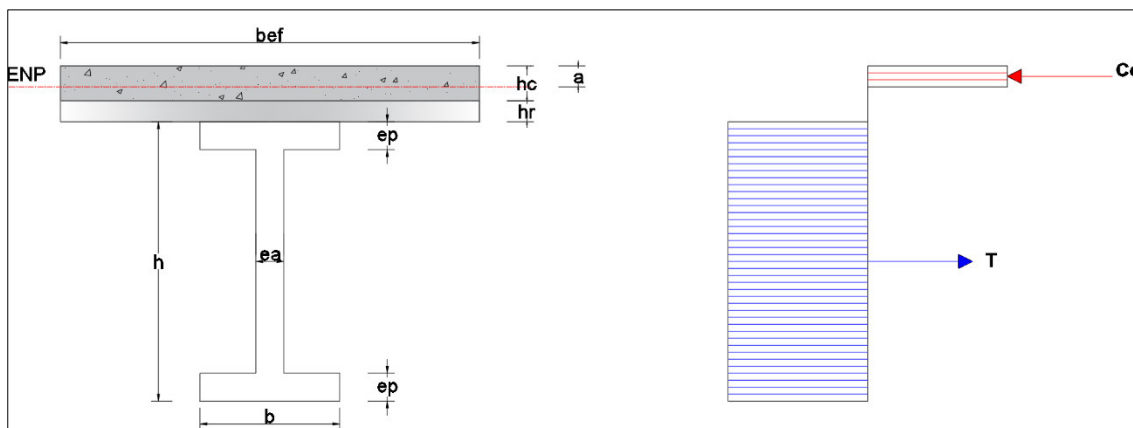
Bloque de esfuerzos con eje neutro en la losa con placa colaborante.
